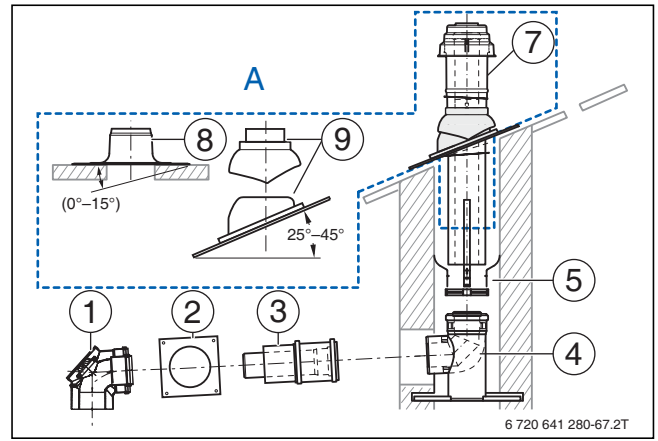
Bauteile Grundbausatz DO-S aus Kunststoff
